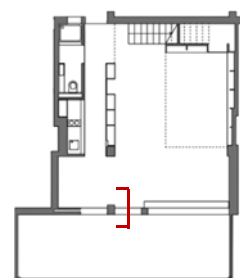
Pormenor Construtivo da impermeabilização do pavimento exterior
